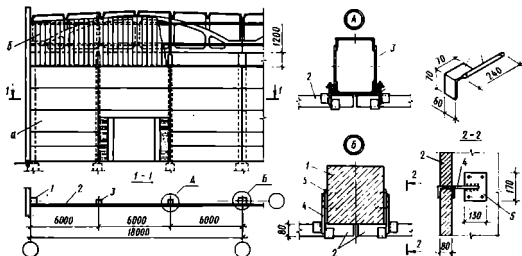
Каркасно-панельные перегородки одноэтажных промышленных зданий (разделительные):
